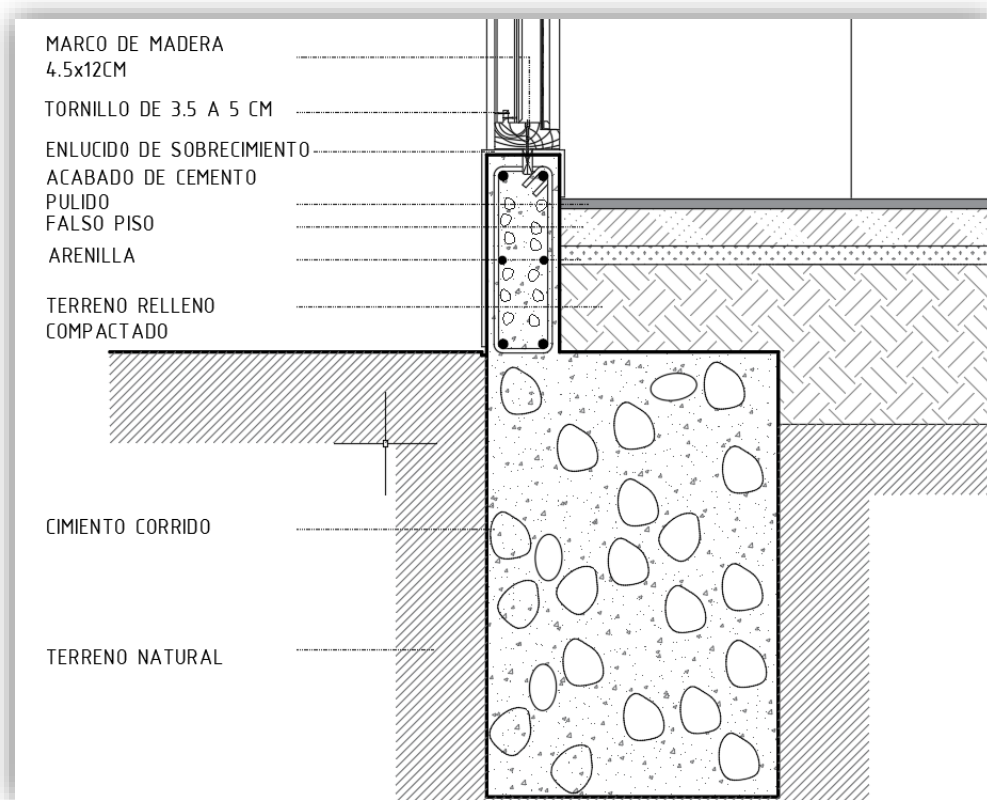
Detalle de pavimento externo e interno. Fuente: propia
